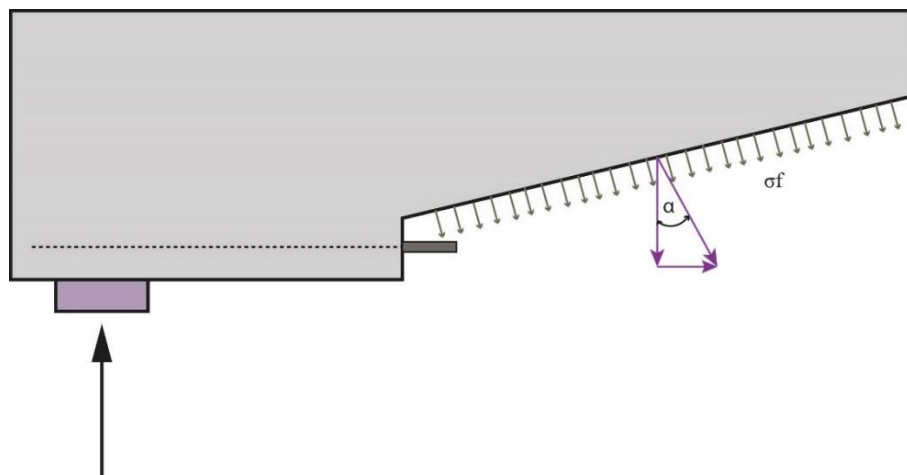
Representación de esfuerzo por fibras de acero en viga de hormigón
